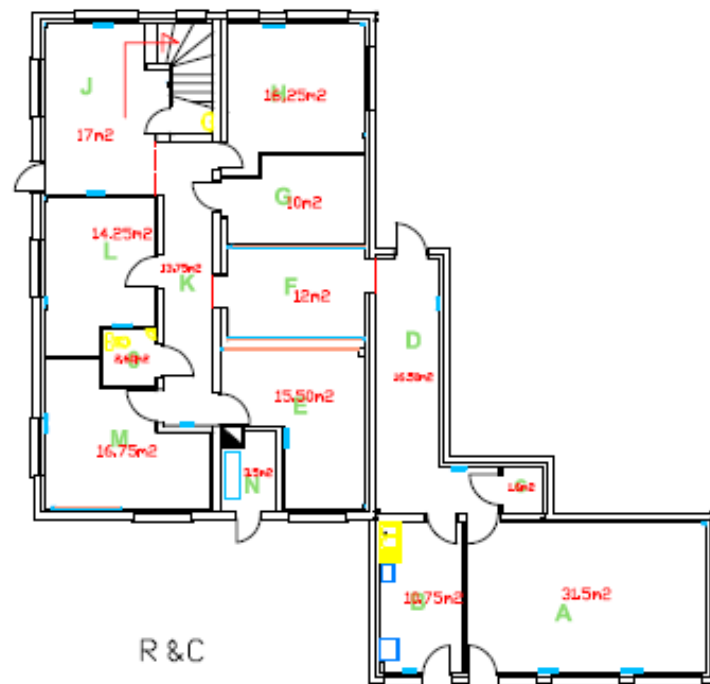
PLAN DU REZ-DE-CHAUSSEE USINE
